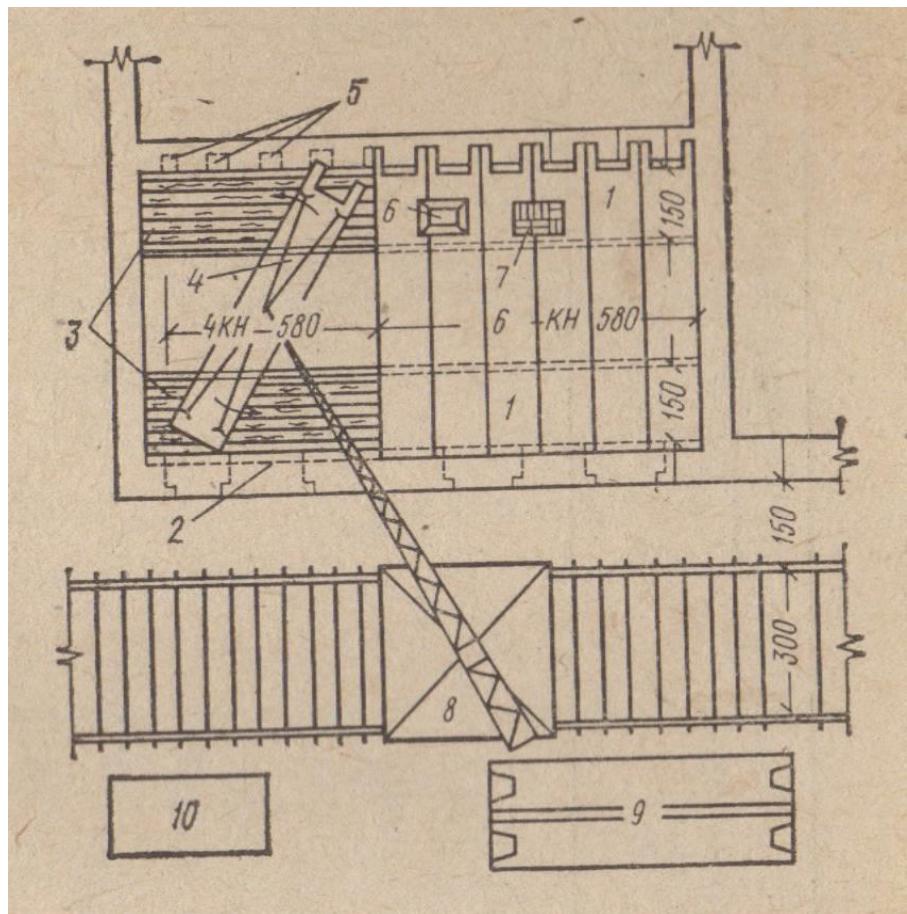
Схема организации работ по монтажу участка перекрытия из железобетонных пустотных настилов с выпускными консолями: 1 – уложенные настилы; 2 – пробитая борозда в наружной стене; 3 – подмости; 4 – монтируемый настил; 5 – пробитые гнезда во внутренней стене; 6 – ящик с раствором; 7 – кирпич; 8 – башенный кран; 9 – железобетонные настилы; 10 – компрессорная станция.
